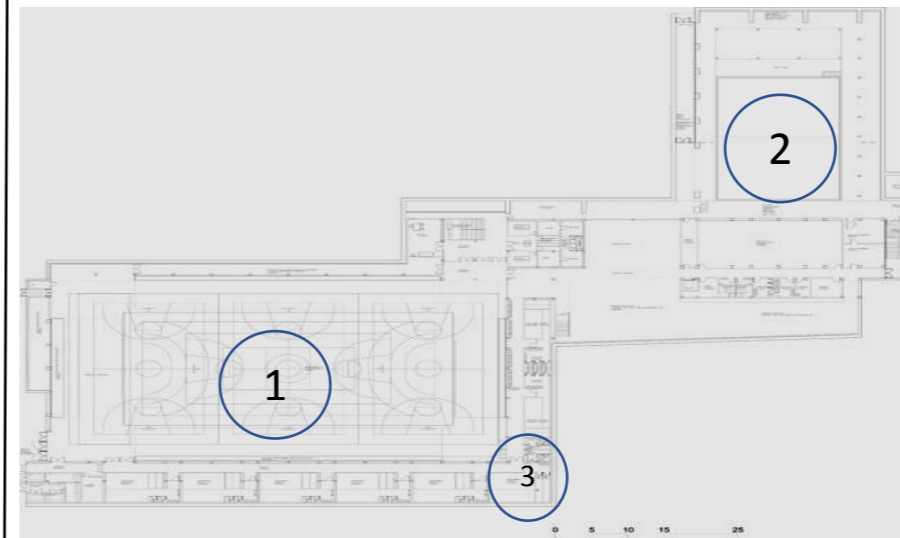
PLAN RDC du centre sportif ACXT ⁽¹¹⁷⁾
